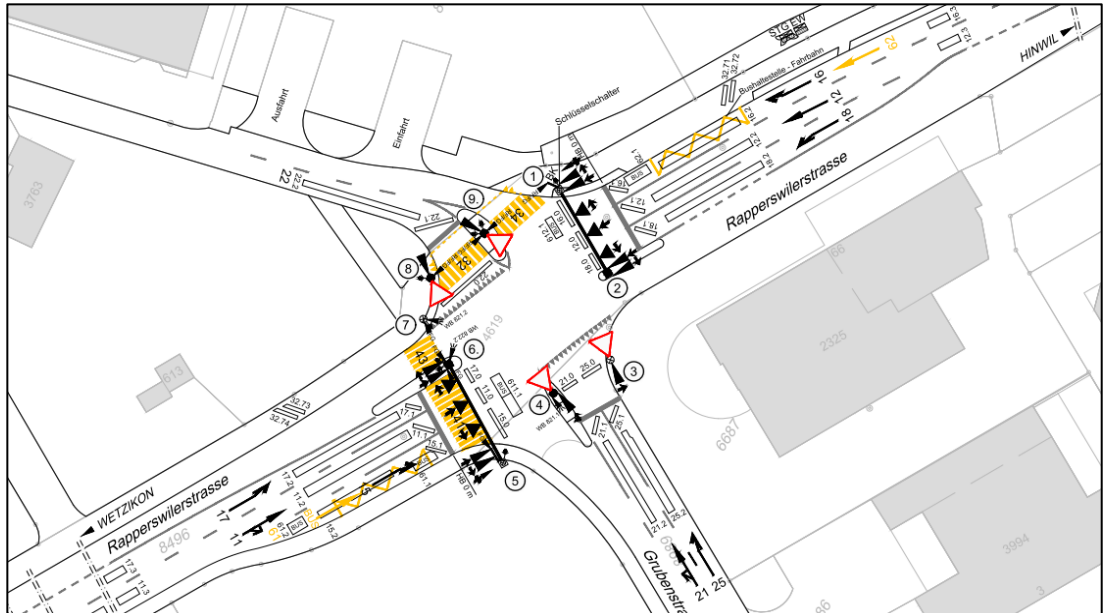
Beispiel Signallageplan LSA Nr. 225
